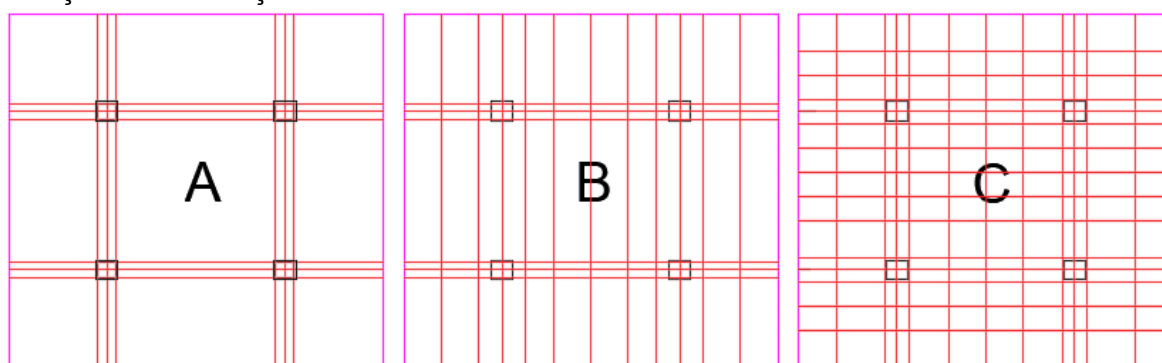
Principais distribuições de cabos em planta esquematizados. (Autor, 2019)
